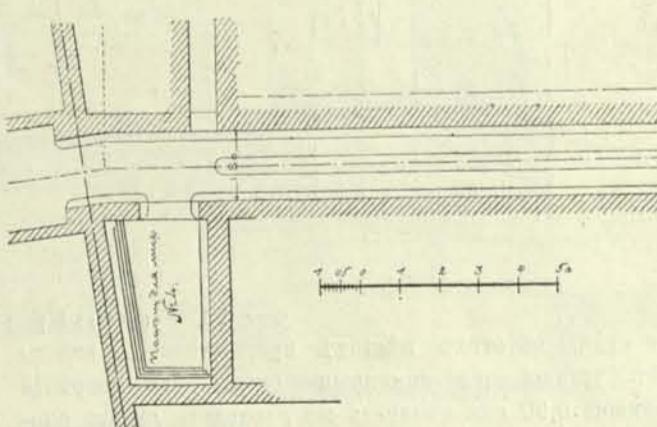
Деталь желѣзобетоннаго покрытія.
